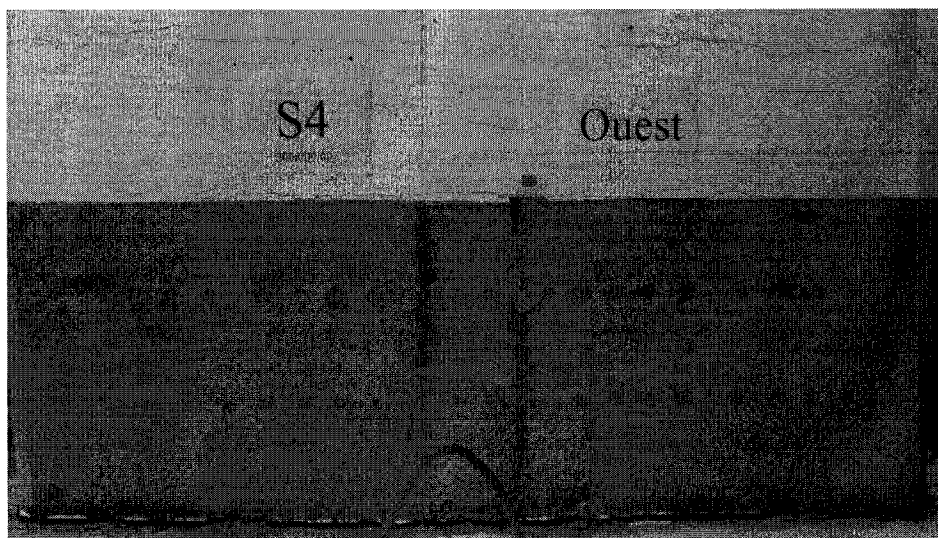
Photo de la face ouest de S4 après avoir enlevé le renforcement
